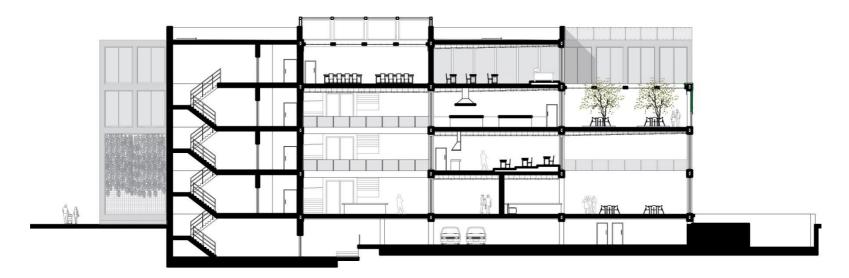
Corte longitudinal 3 Fuente: elaboración propia
